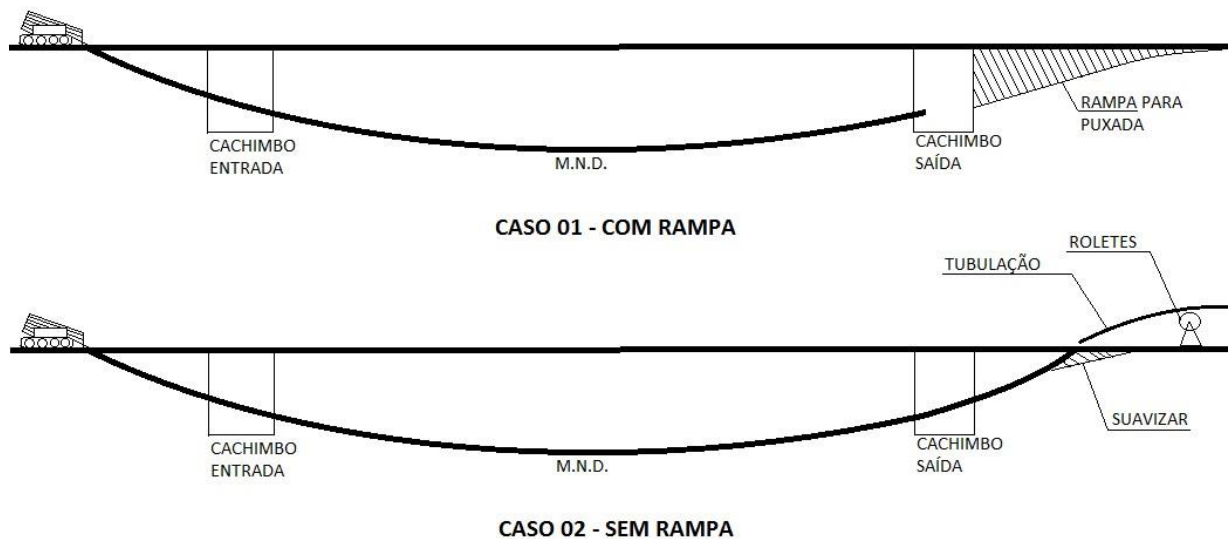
Ilustração de perfil de M.N.D. com ou sem rampa.
